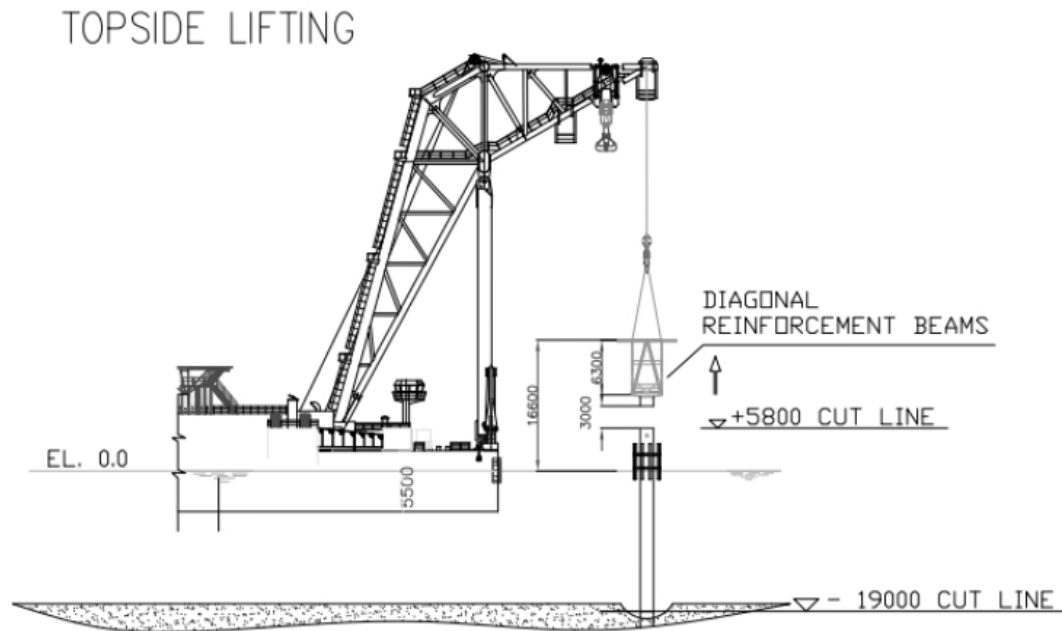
Piattaforma Armida 1 – Sketch di Rimozione Ponte tipico utilizzando Nave Gru a Braccio Fisso
